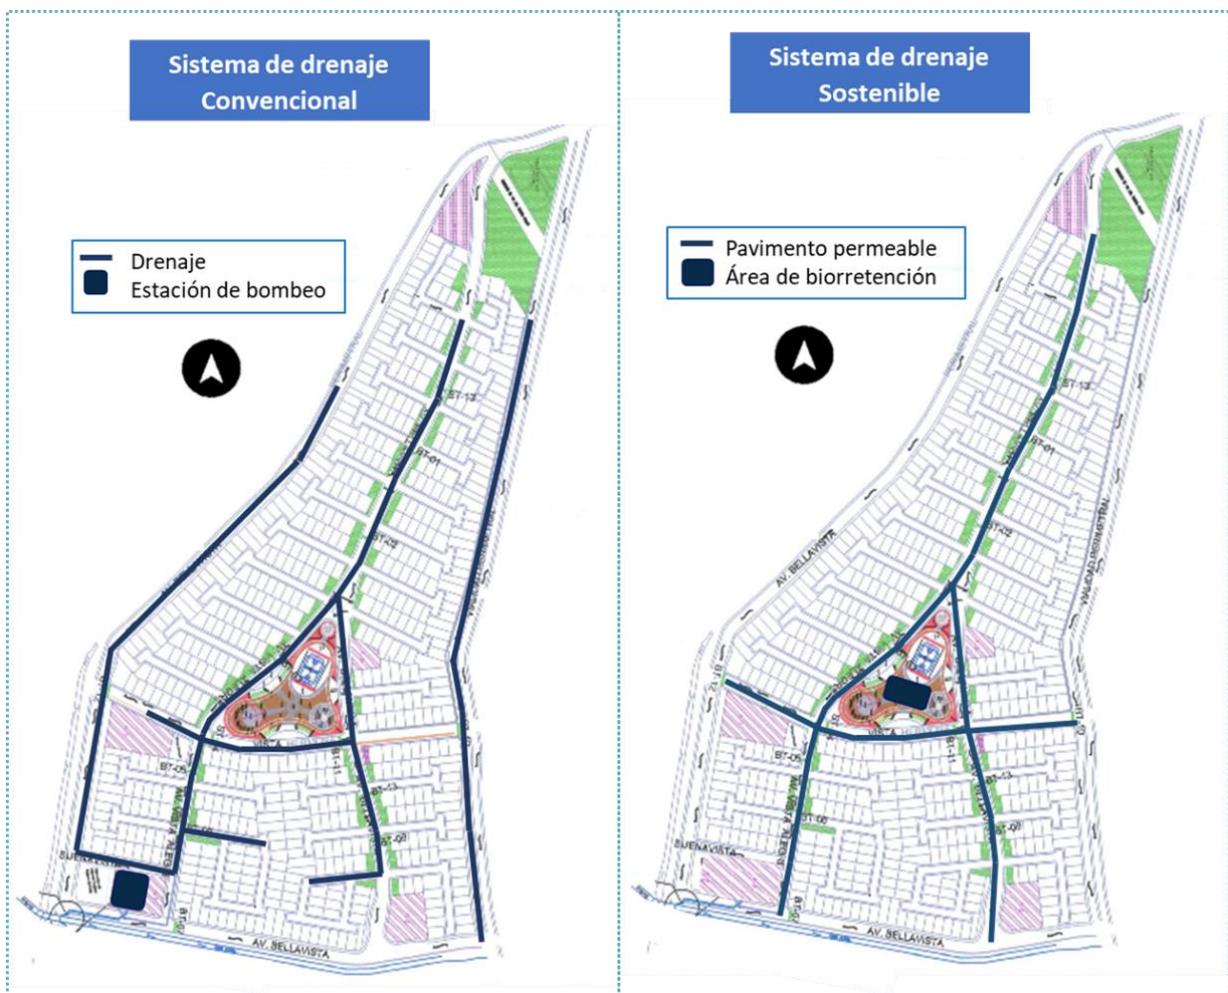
Sistema de drenaje pluvial Fraccionamiento Rancho Bellavista
